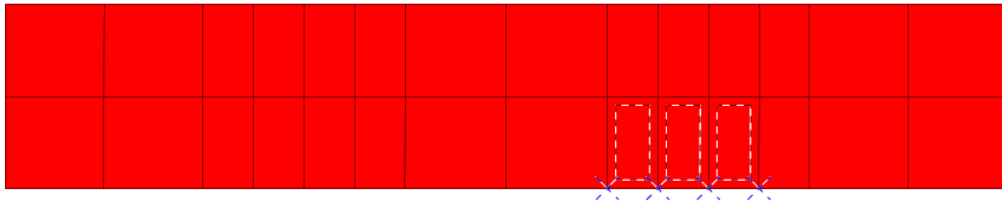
Modello 3D – Section cut Muro Paragliaia
